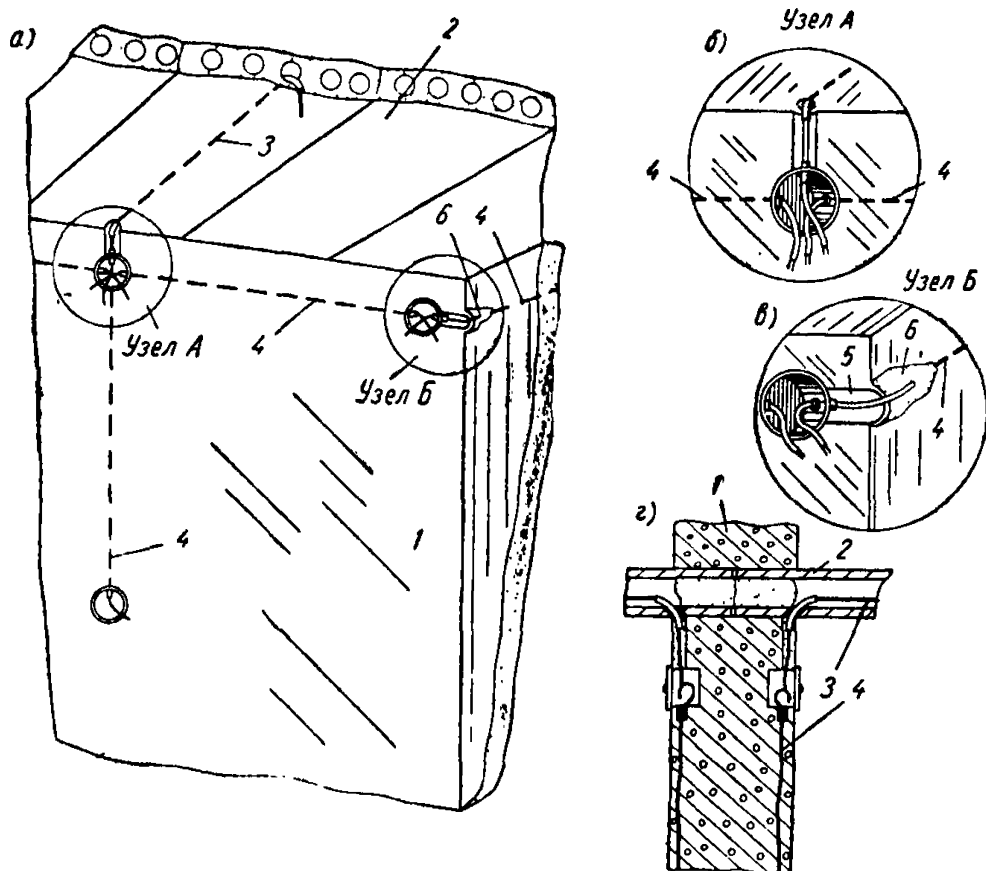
Узлы сопряжения электропроводок, замоноличенных в стеновые панели при изготовлении на заводе (случай, когда к потолочным светильникам провода прокладываются в пустотах панелей перекрытия)
